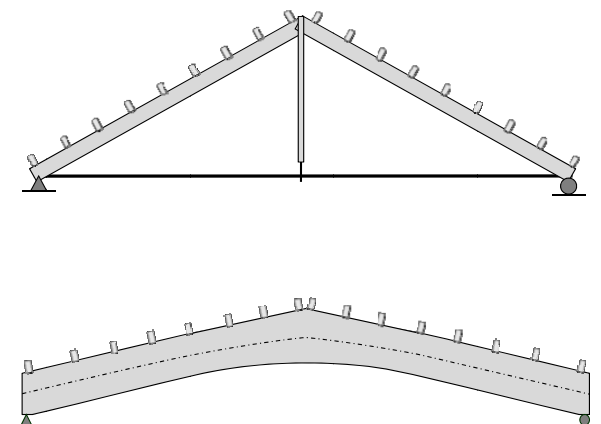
Tetto con struttura a capriate o con travi portanti di forma particolare
